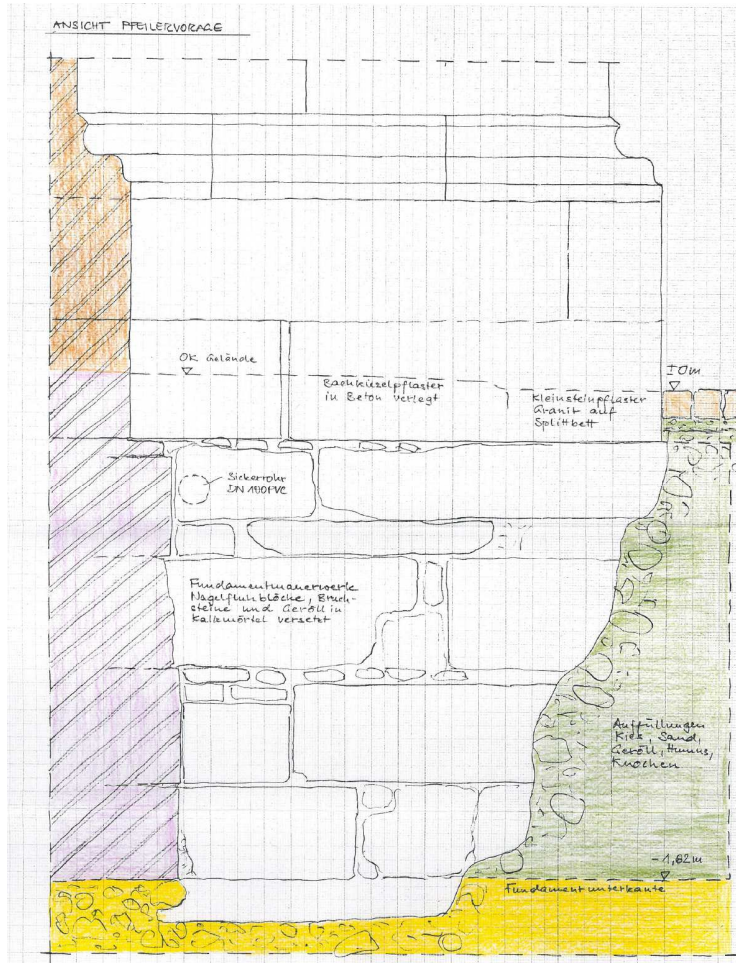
Steyr, Stadtpfarrkirche, Aufnahmeskizze Fundamentuntersuchung Südfassade
